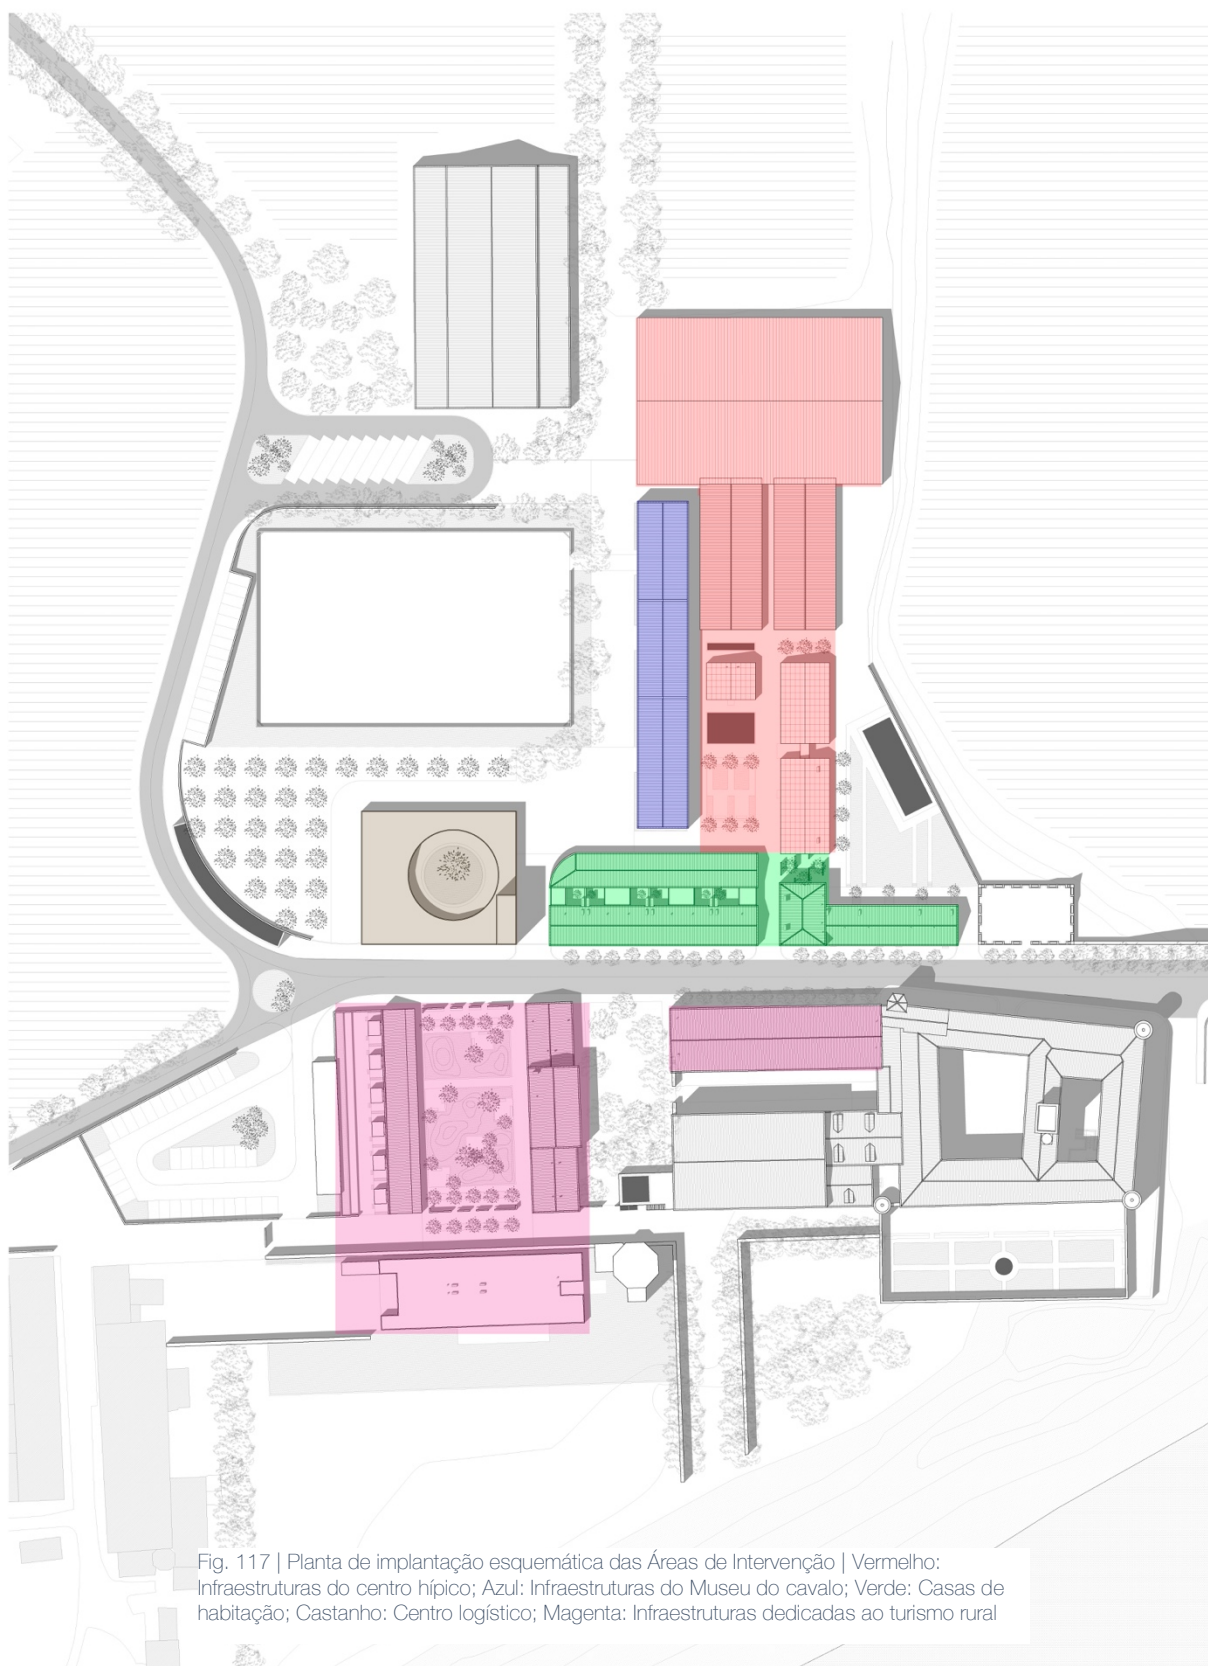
| Planta de implantação esquemática das Áreas de Intervenção | Vermelho: Infraestruturas do centro hípico; Azul: Infraestruturas do Museu do cavalo; Verde: Casas de habitação; Castanho: Centro logístico; Magenta: Infraestruturas dedicadas ao turismo rural
